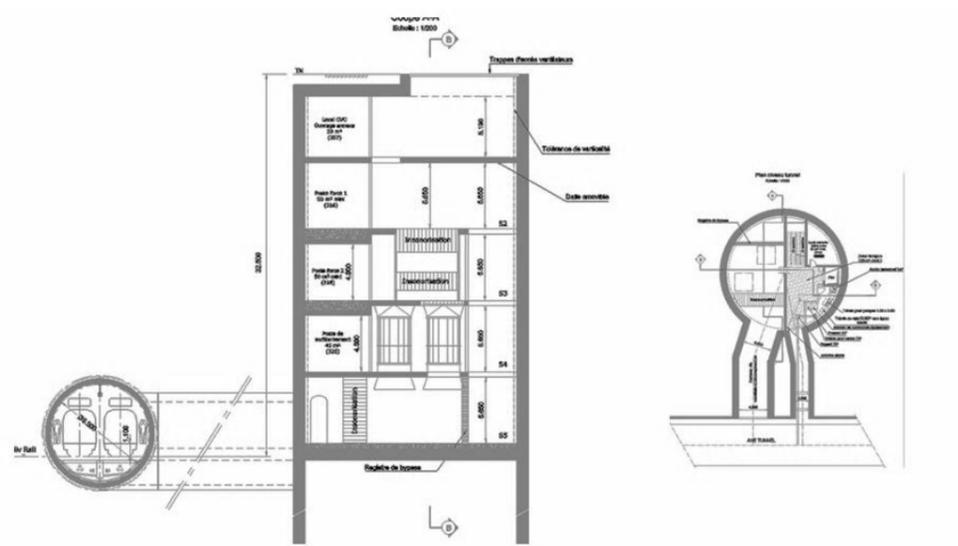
Coupe et vue en plan au niveau du cheminement OA Circulaire type A
